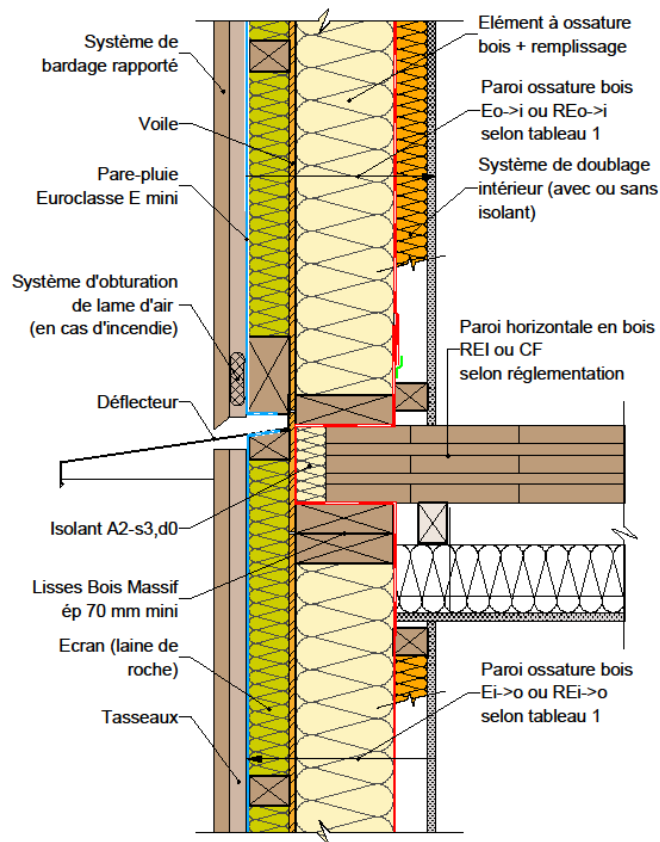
Façade/mur ossature bois & plancher en panneau bois massif.
